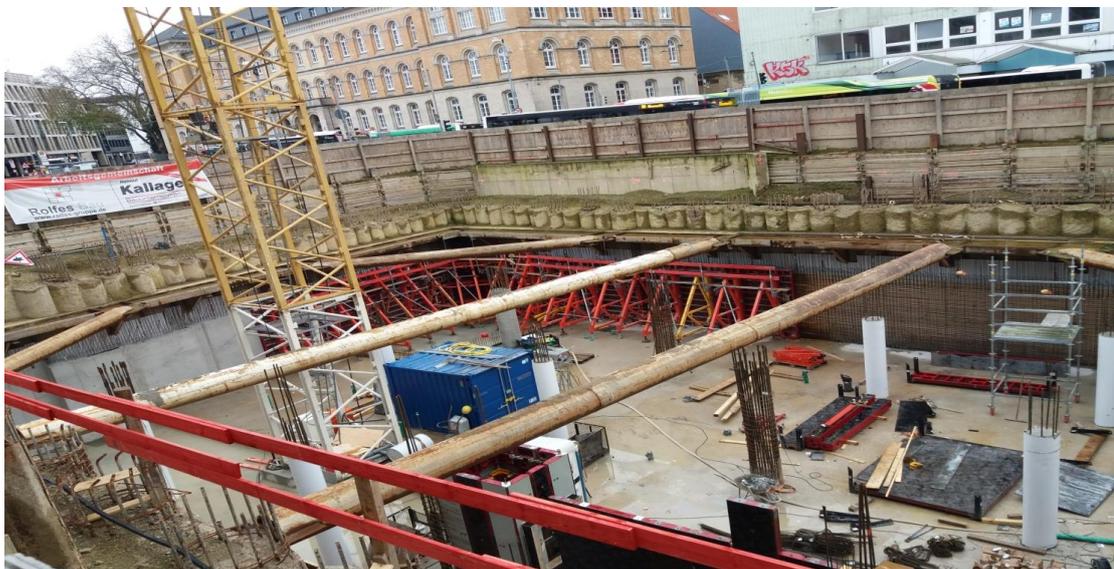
Армирование и установка опалубки стен, наращивание башни крана
